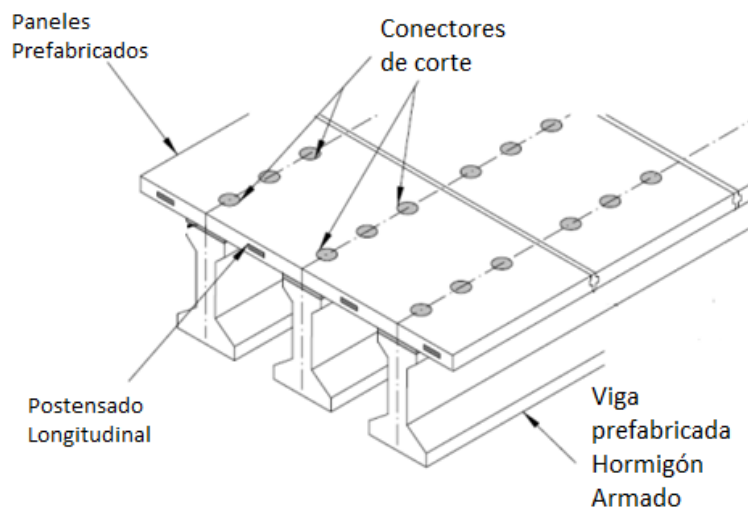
Conectores de Corte para Paneles Prefabricados. Fuente: Recommendations for the Connection Between Full-Depth Precast Bridge Deck Panel Systems and Precast I-Beams (2007).
